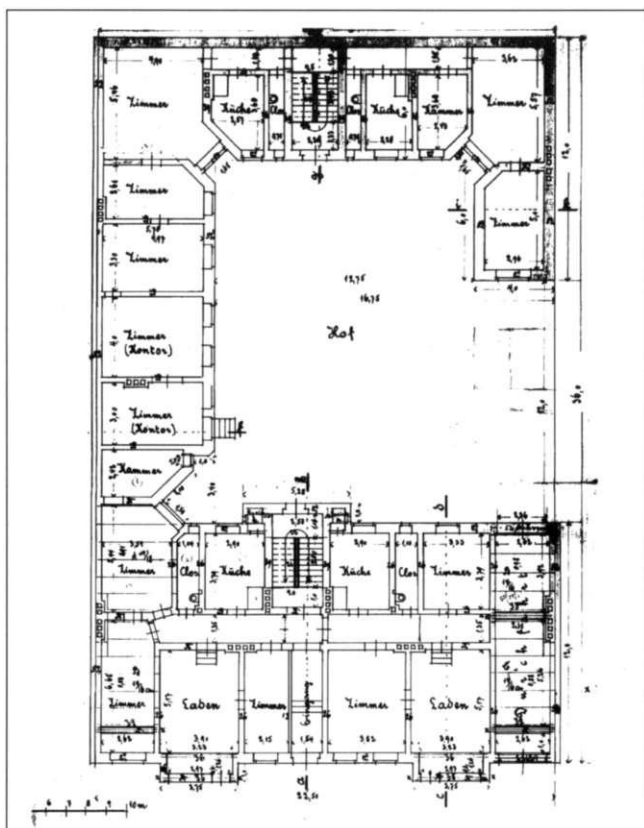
Olvenstedter Straße 15, Erdgeschoß, Grundrißtyp F
